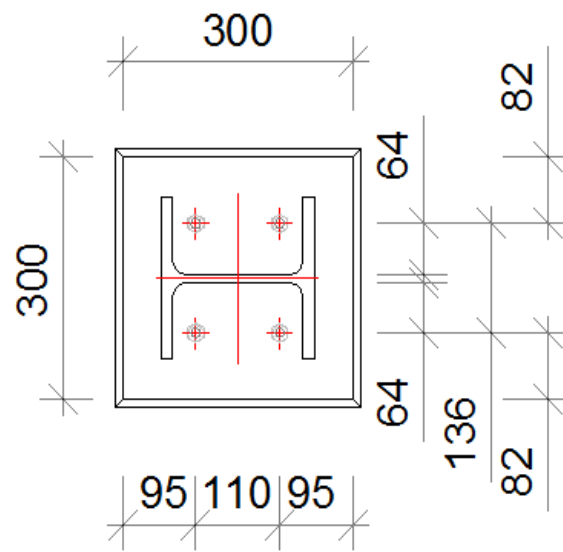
CORTE ESTRUTURAL (AUTOCAD)
